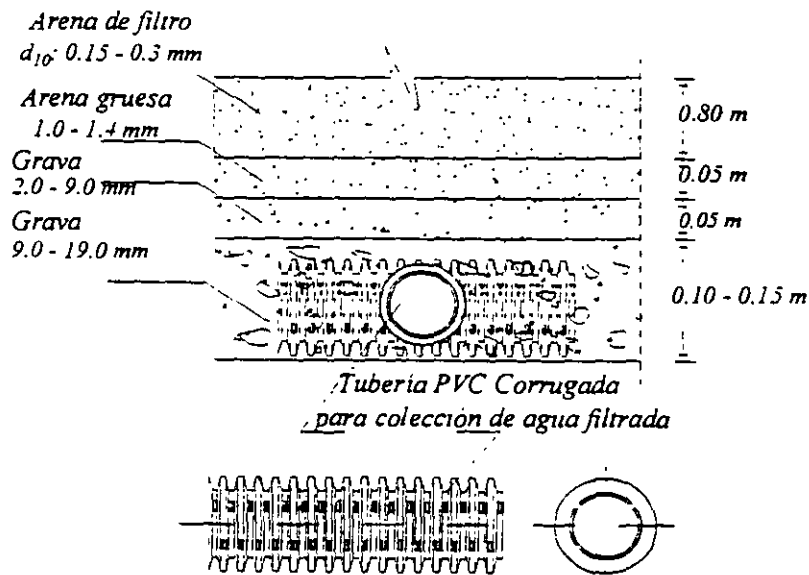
Medio de soporte y tubería de drenaje de un filtro lento en arena.
